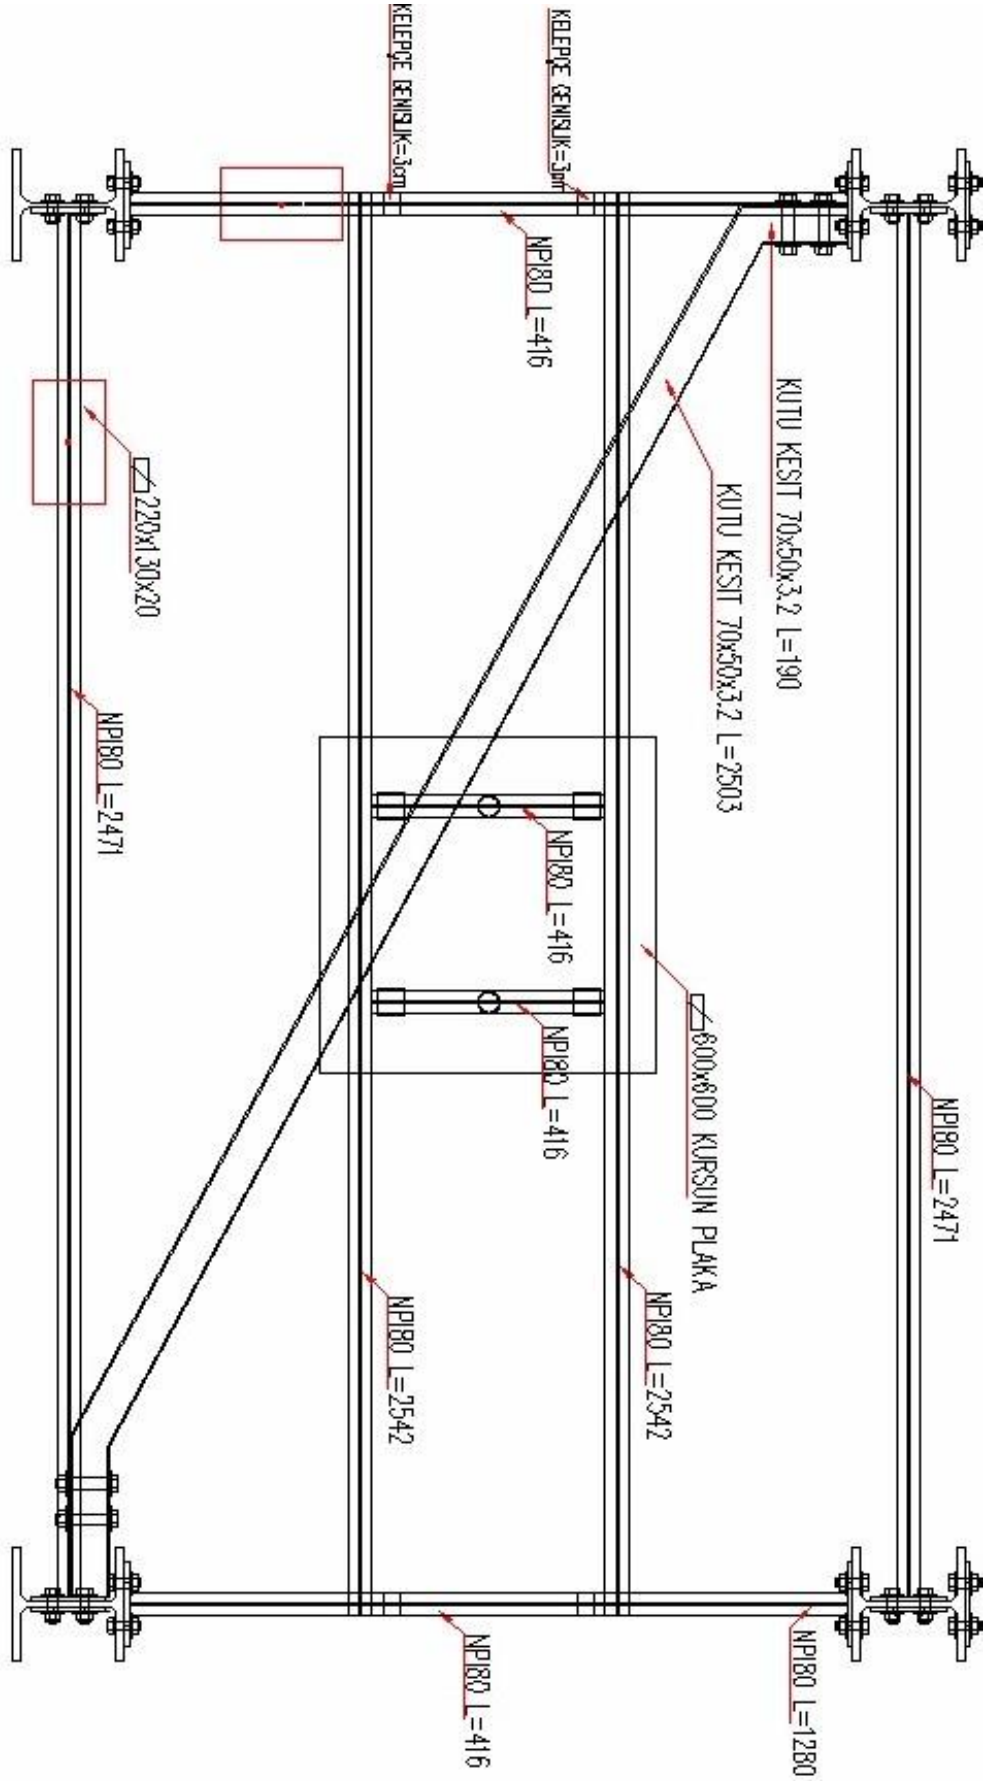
Kolon başlığına bağlanmış kiriş detayı ve bağlantı levhaları
